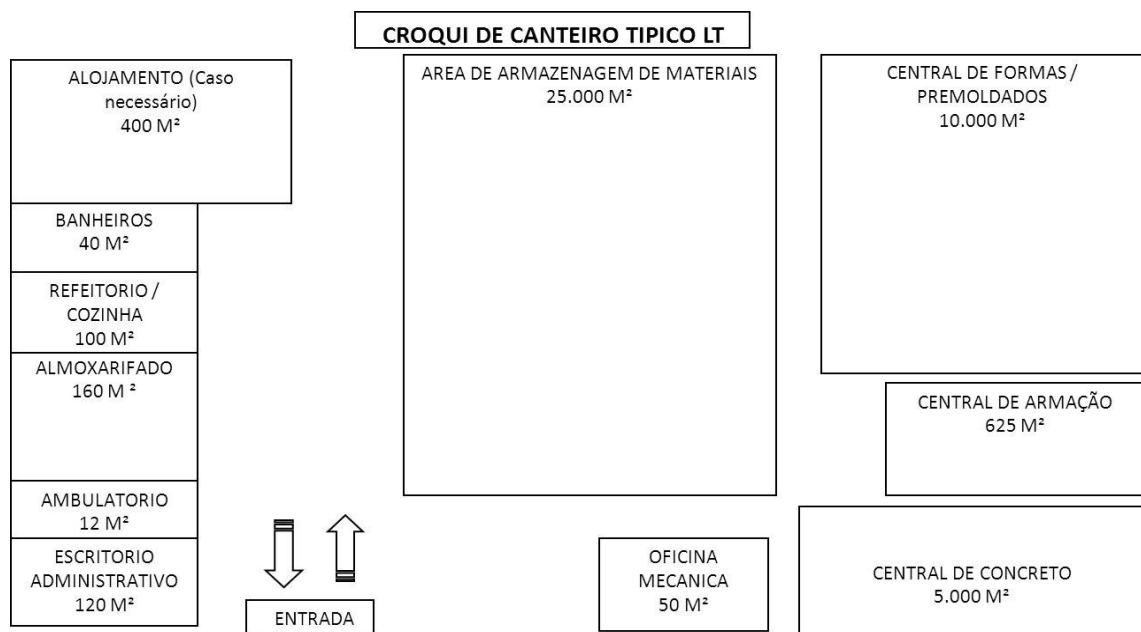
Layout de Canteiro de Obra típico de LT.
